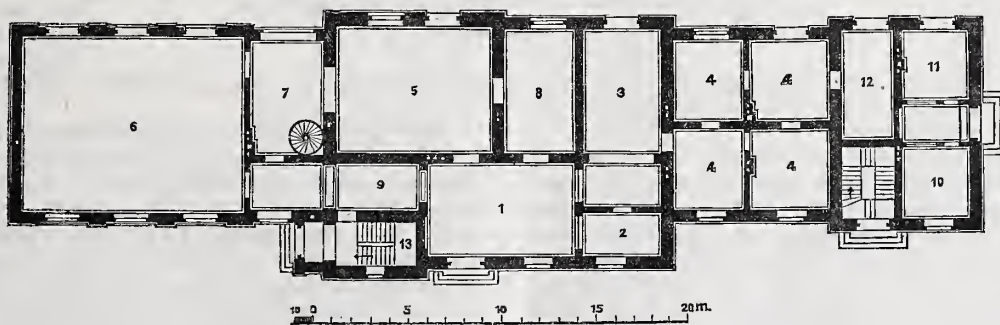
Grundriss vom Erdgeschoss.
